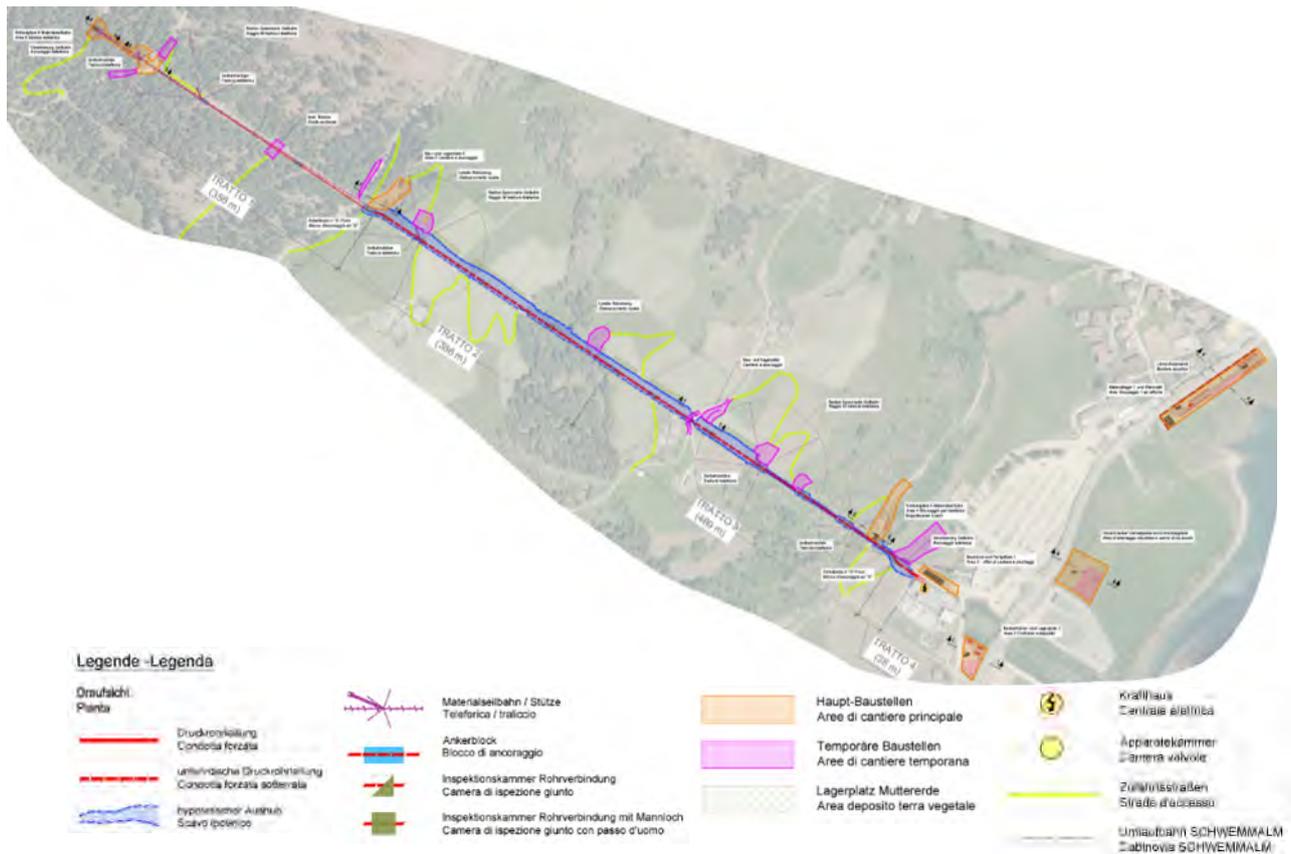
Planimetria con localizzazione delle aree di cantiere.
